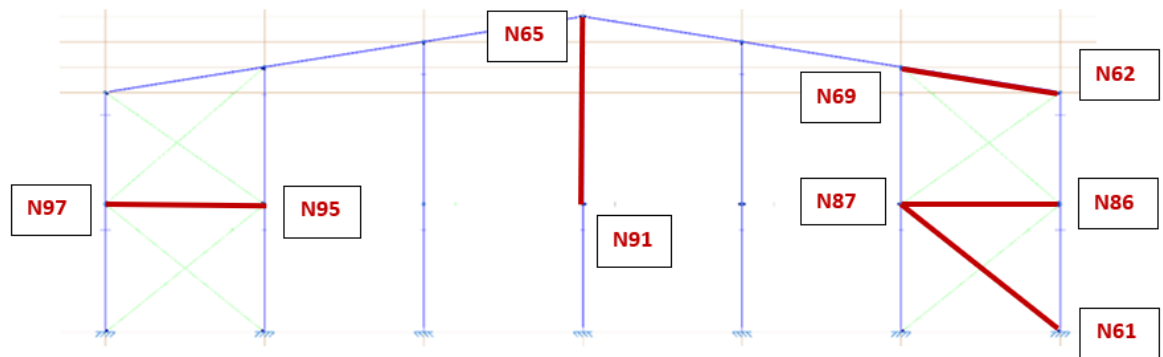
Pórtico de fachada, selección de barras. (CYPE 3D).
